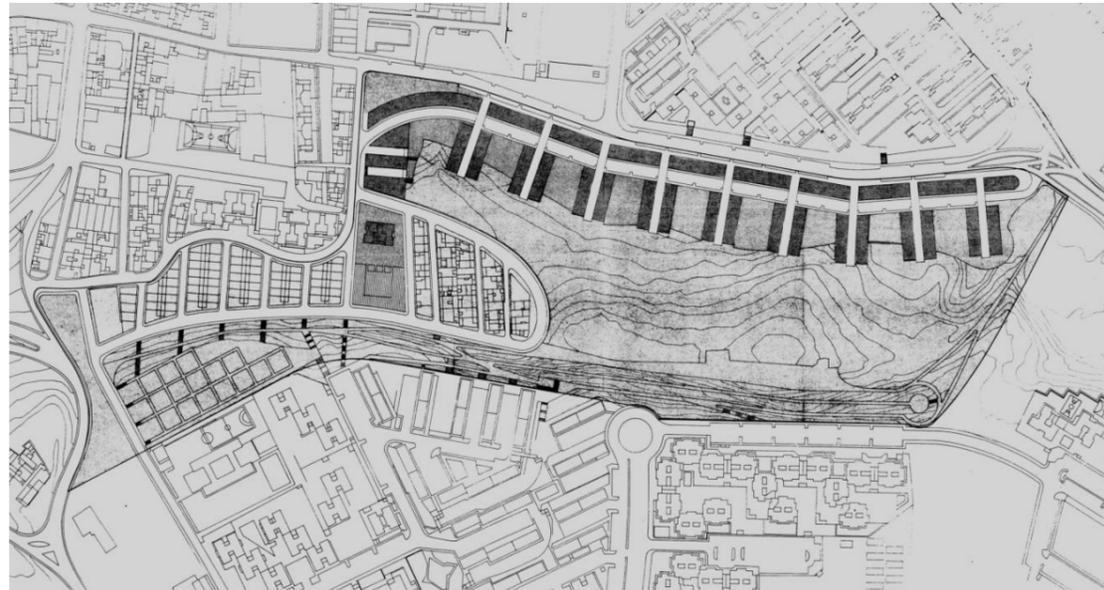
Plano de Estructura urbana reformada. Detalle (Documento de avance P.E.R.I 2F)
